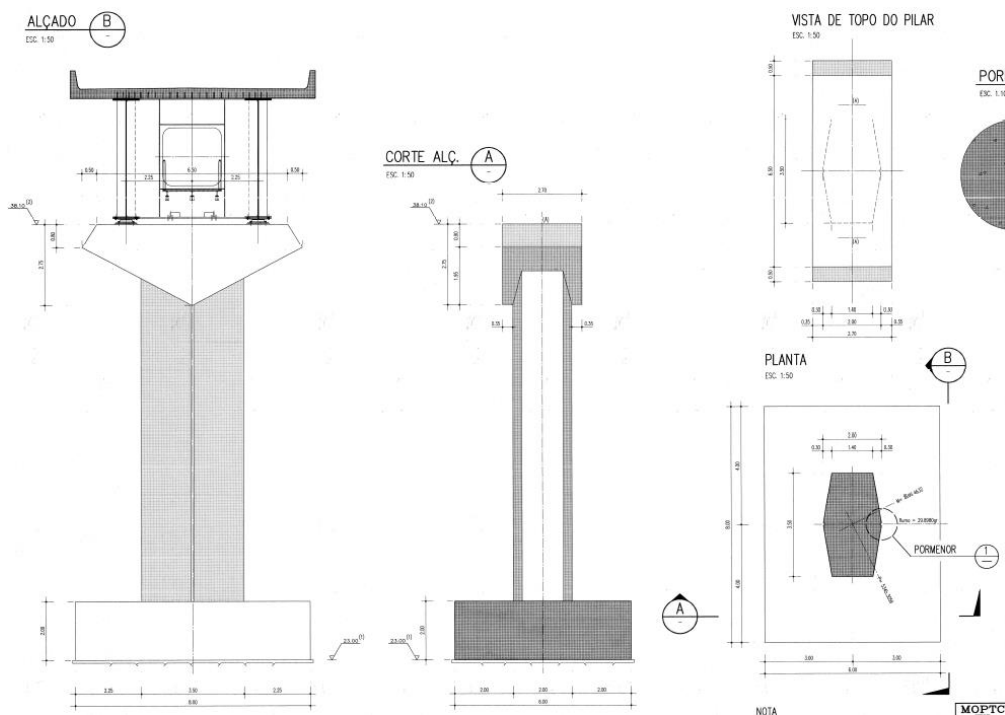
Pilar P19A (Peça desenhada nº 76 do Projeto de Execução 1996)
